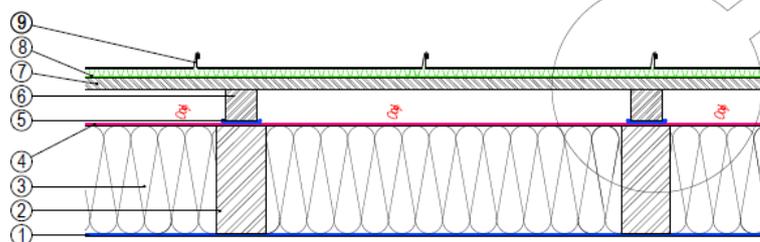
Конструкция крыши с металлической кровлей, ОДМ и диффузионной мембраной, уложенной на утеплитель. Фальцевая кровля смонтирована на ОДМ поверх сплошного настила.
